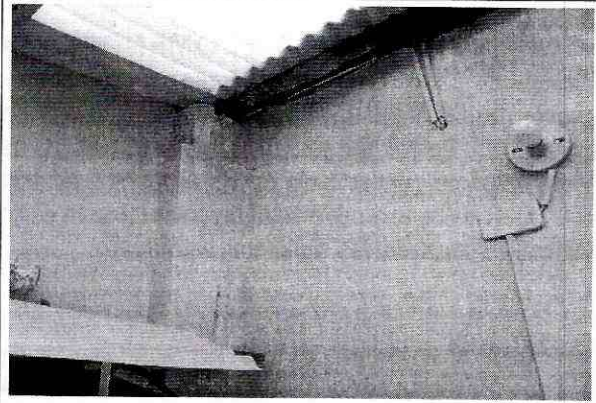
Fisuras en muro de lindero del costado norte.
